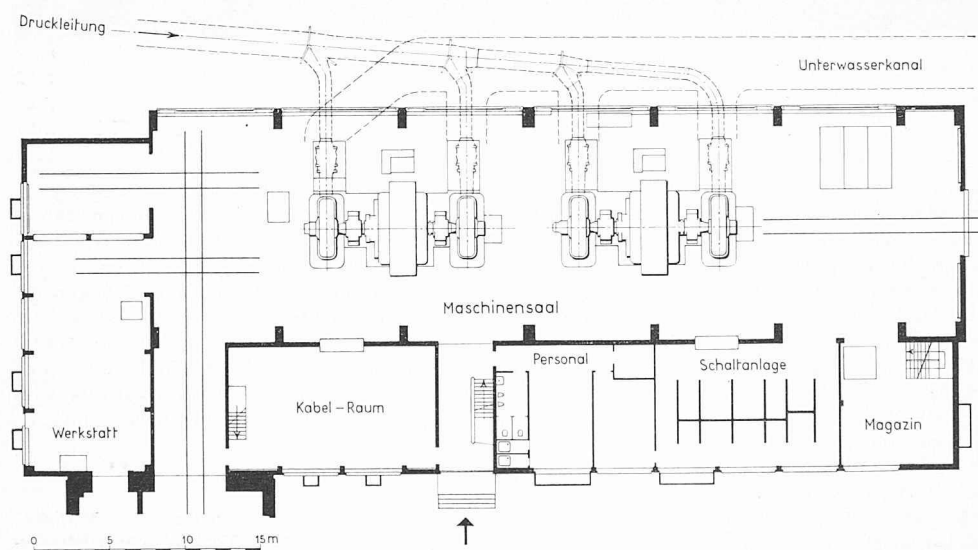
Grundriss 1:500 des Maschinenhauses Ackersand II
